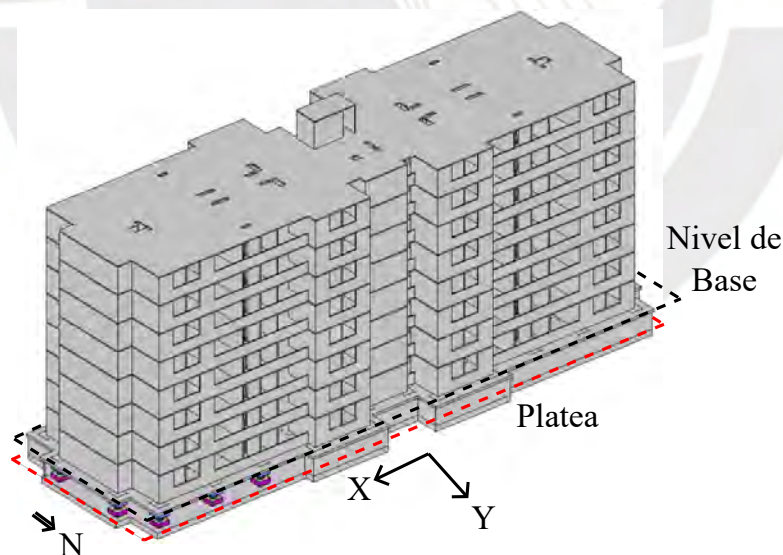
Vista en 3D del edificio aislado sísmicamente y parte de su sistema de aislamiento.
